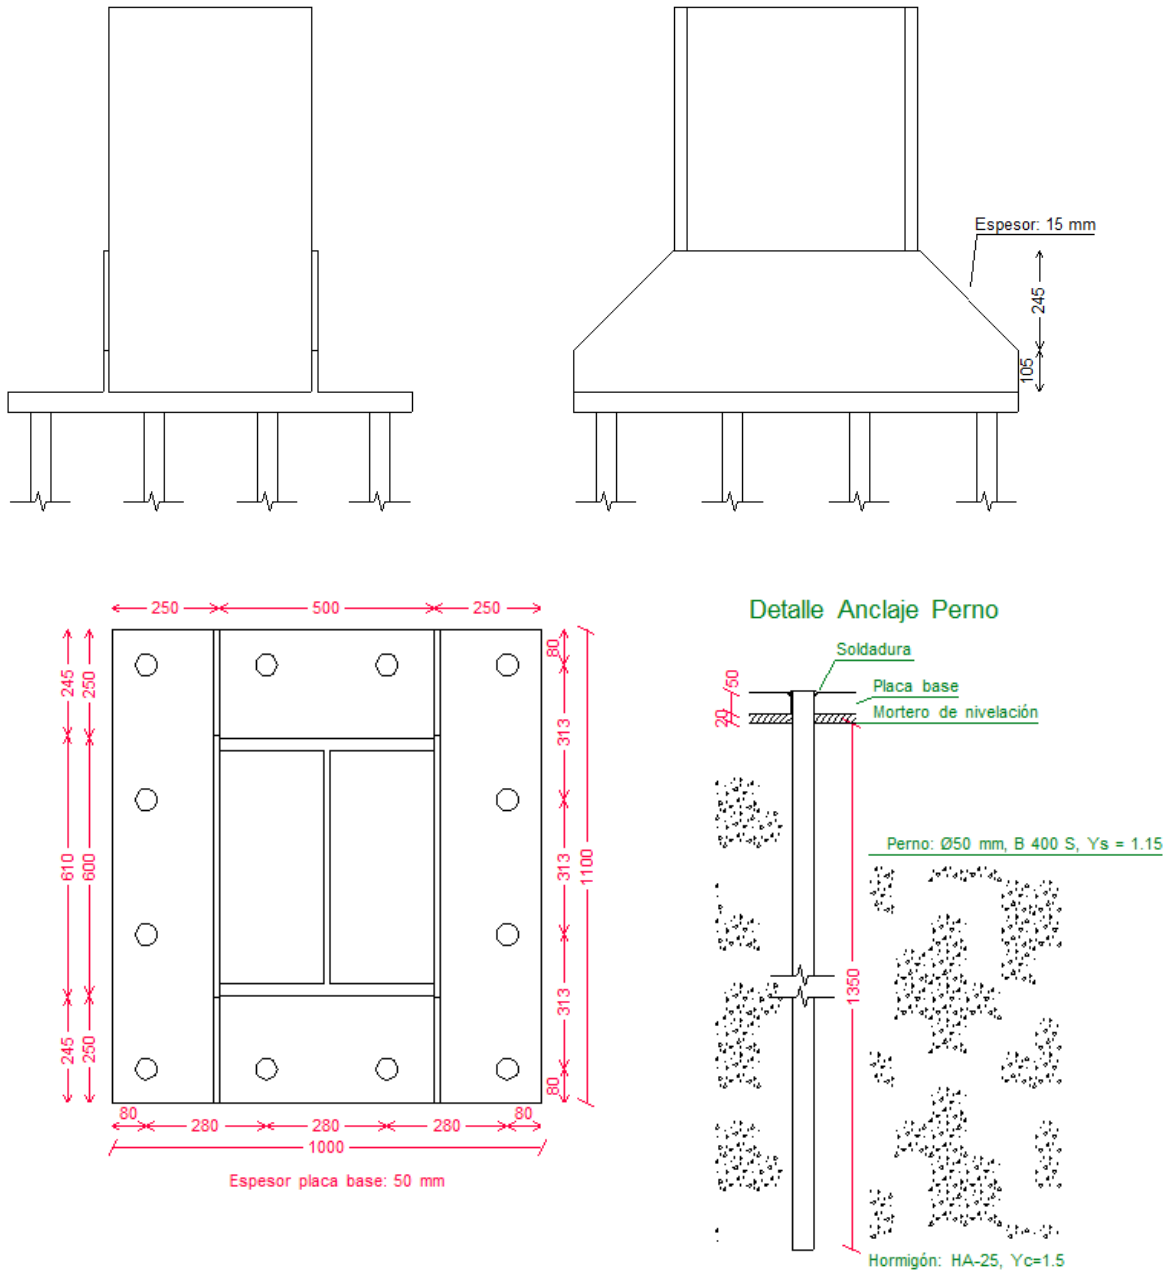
Placa de Anclaje Tipo 2. (Fachadas laterales)
